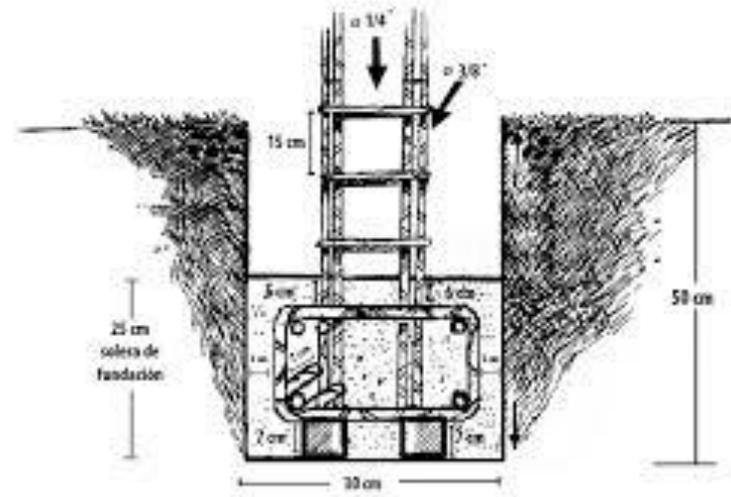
esquema de construcción de fundaciones con concreto armado.
